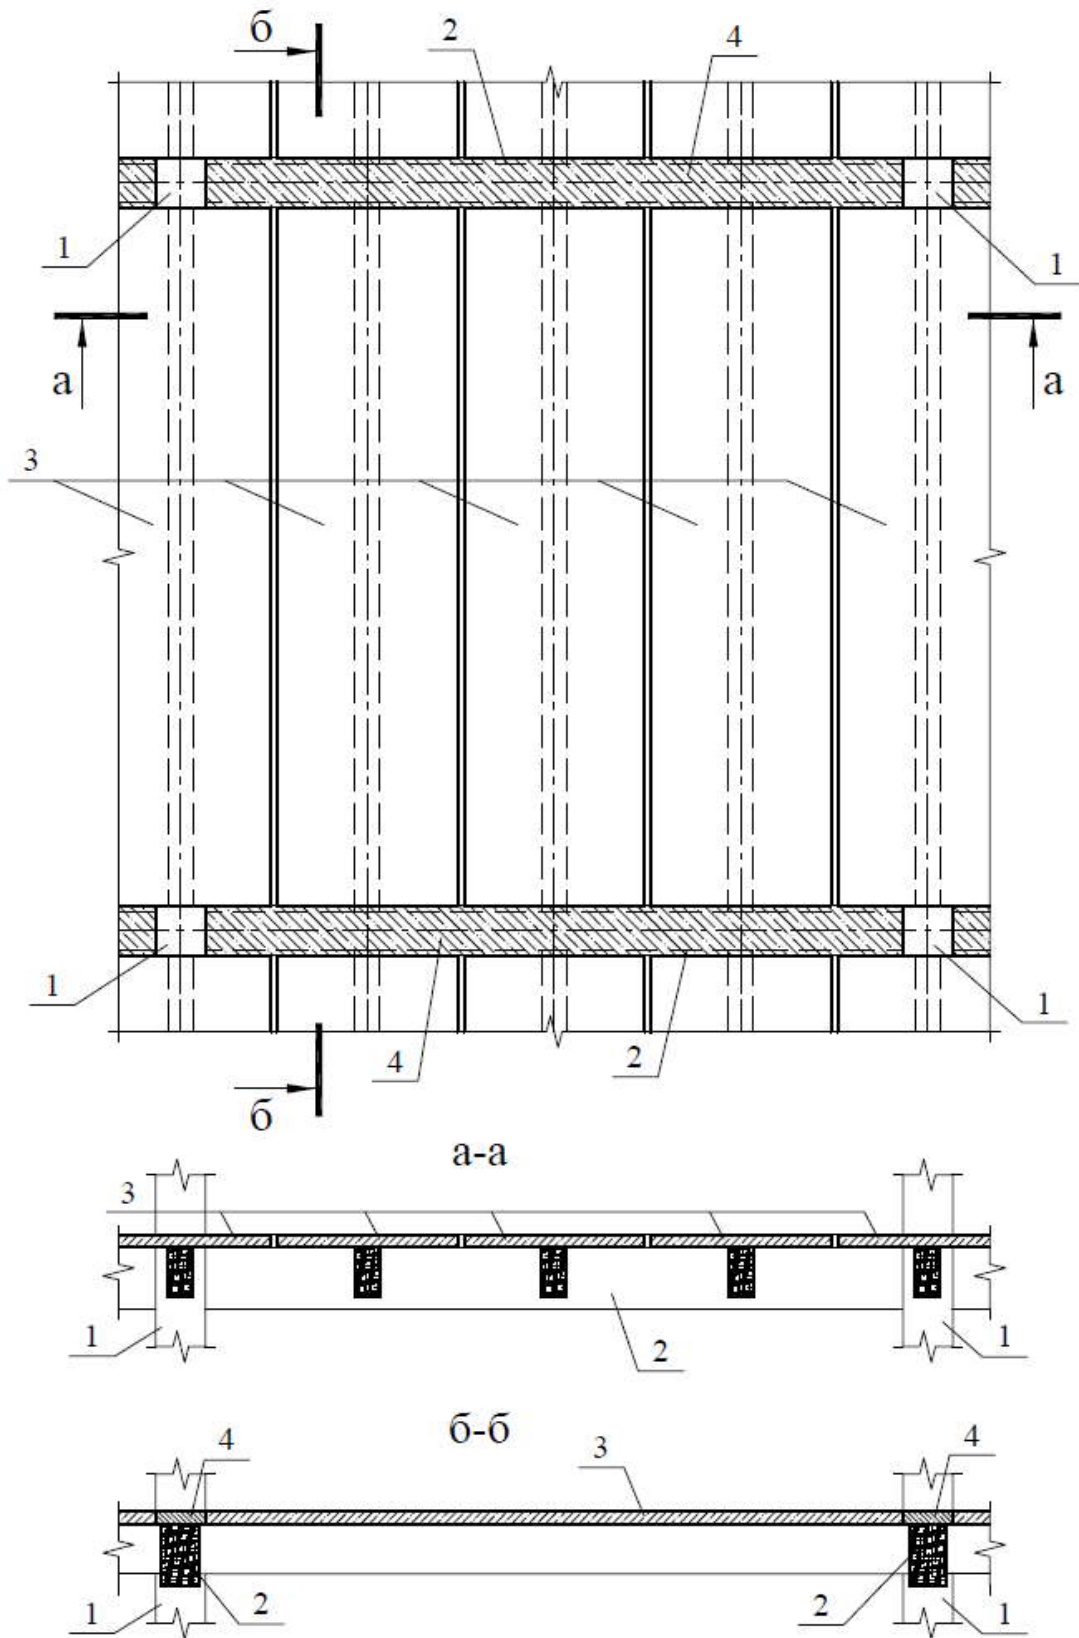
Схема збірного гібридного деревобетонного перекриття: 1 – $L < Y$ колони; 2 – головні балки; 3 – другорядні деревобетонні балки таврового перерізу; 4 – бетон замонолічування
